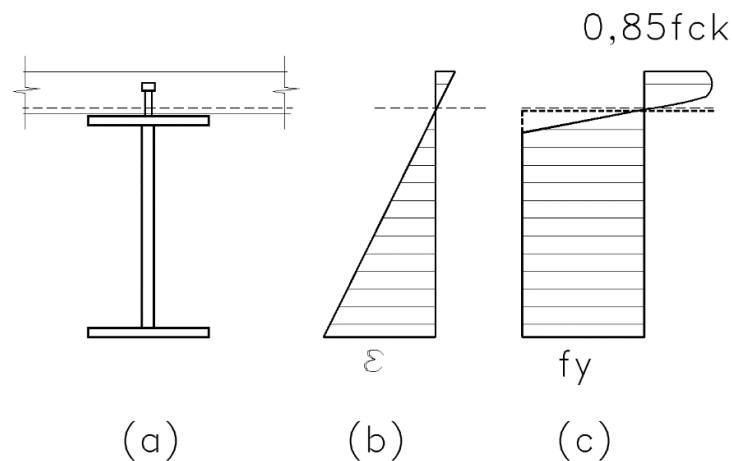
Esquema estructural simple, viga metálica, conectores y mesa de compresión. ABNT (2008)
